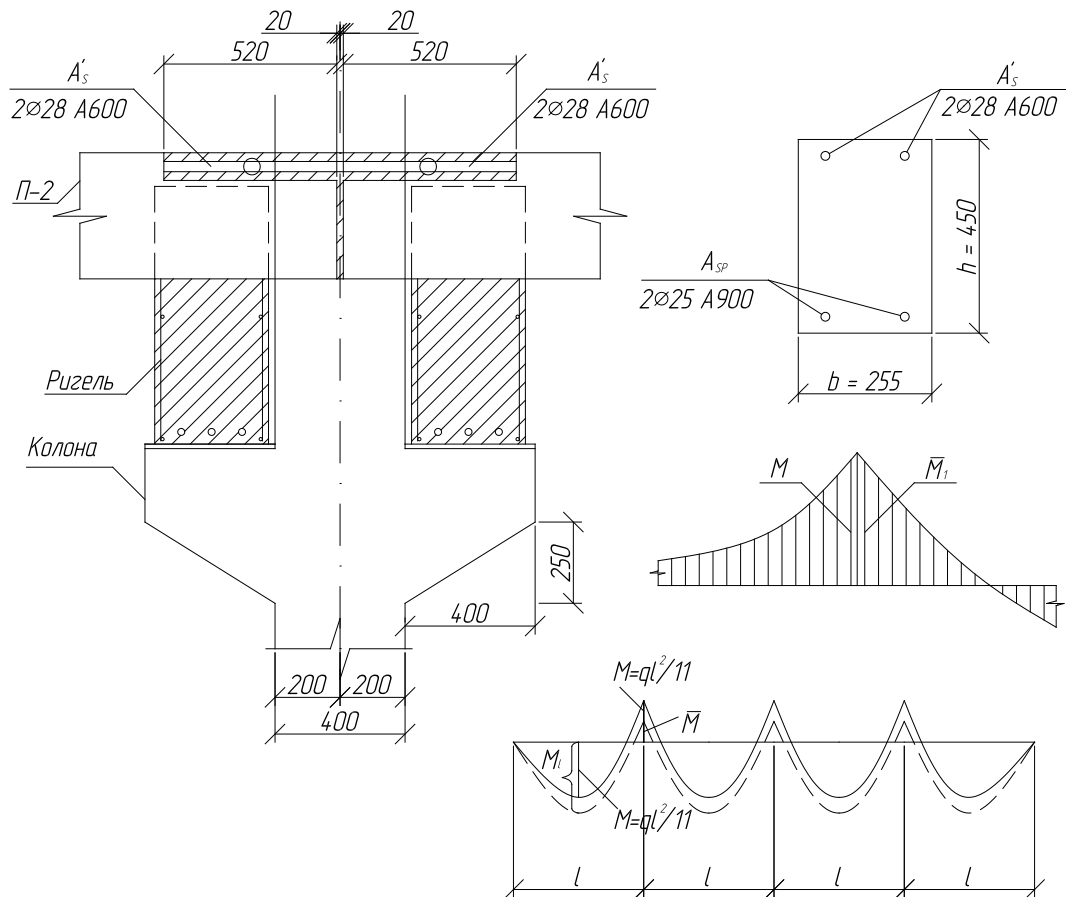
До розрахунку площі попередньо-напруженої арматури плити.
